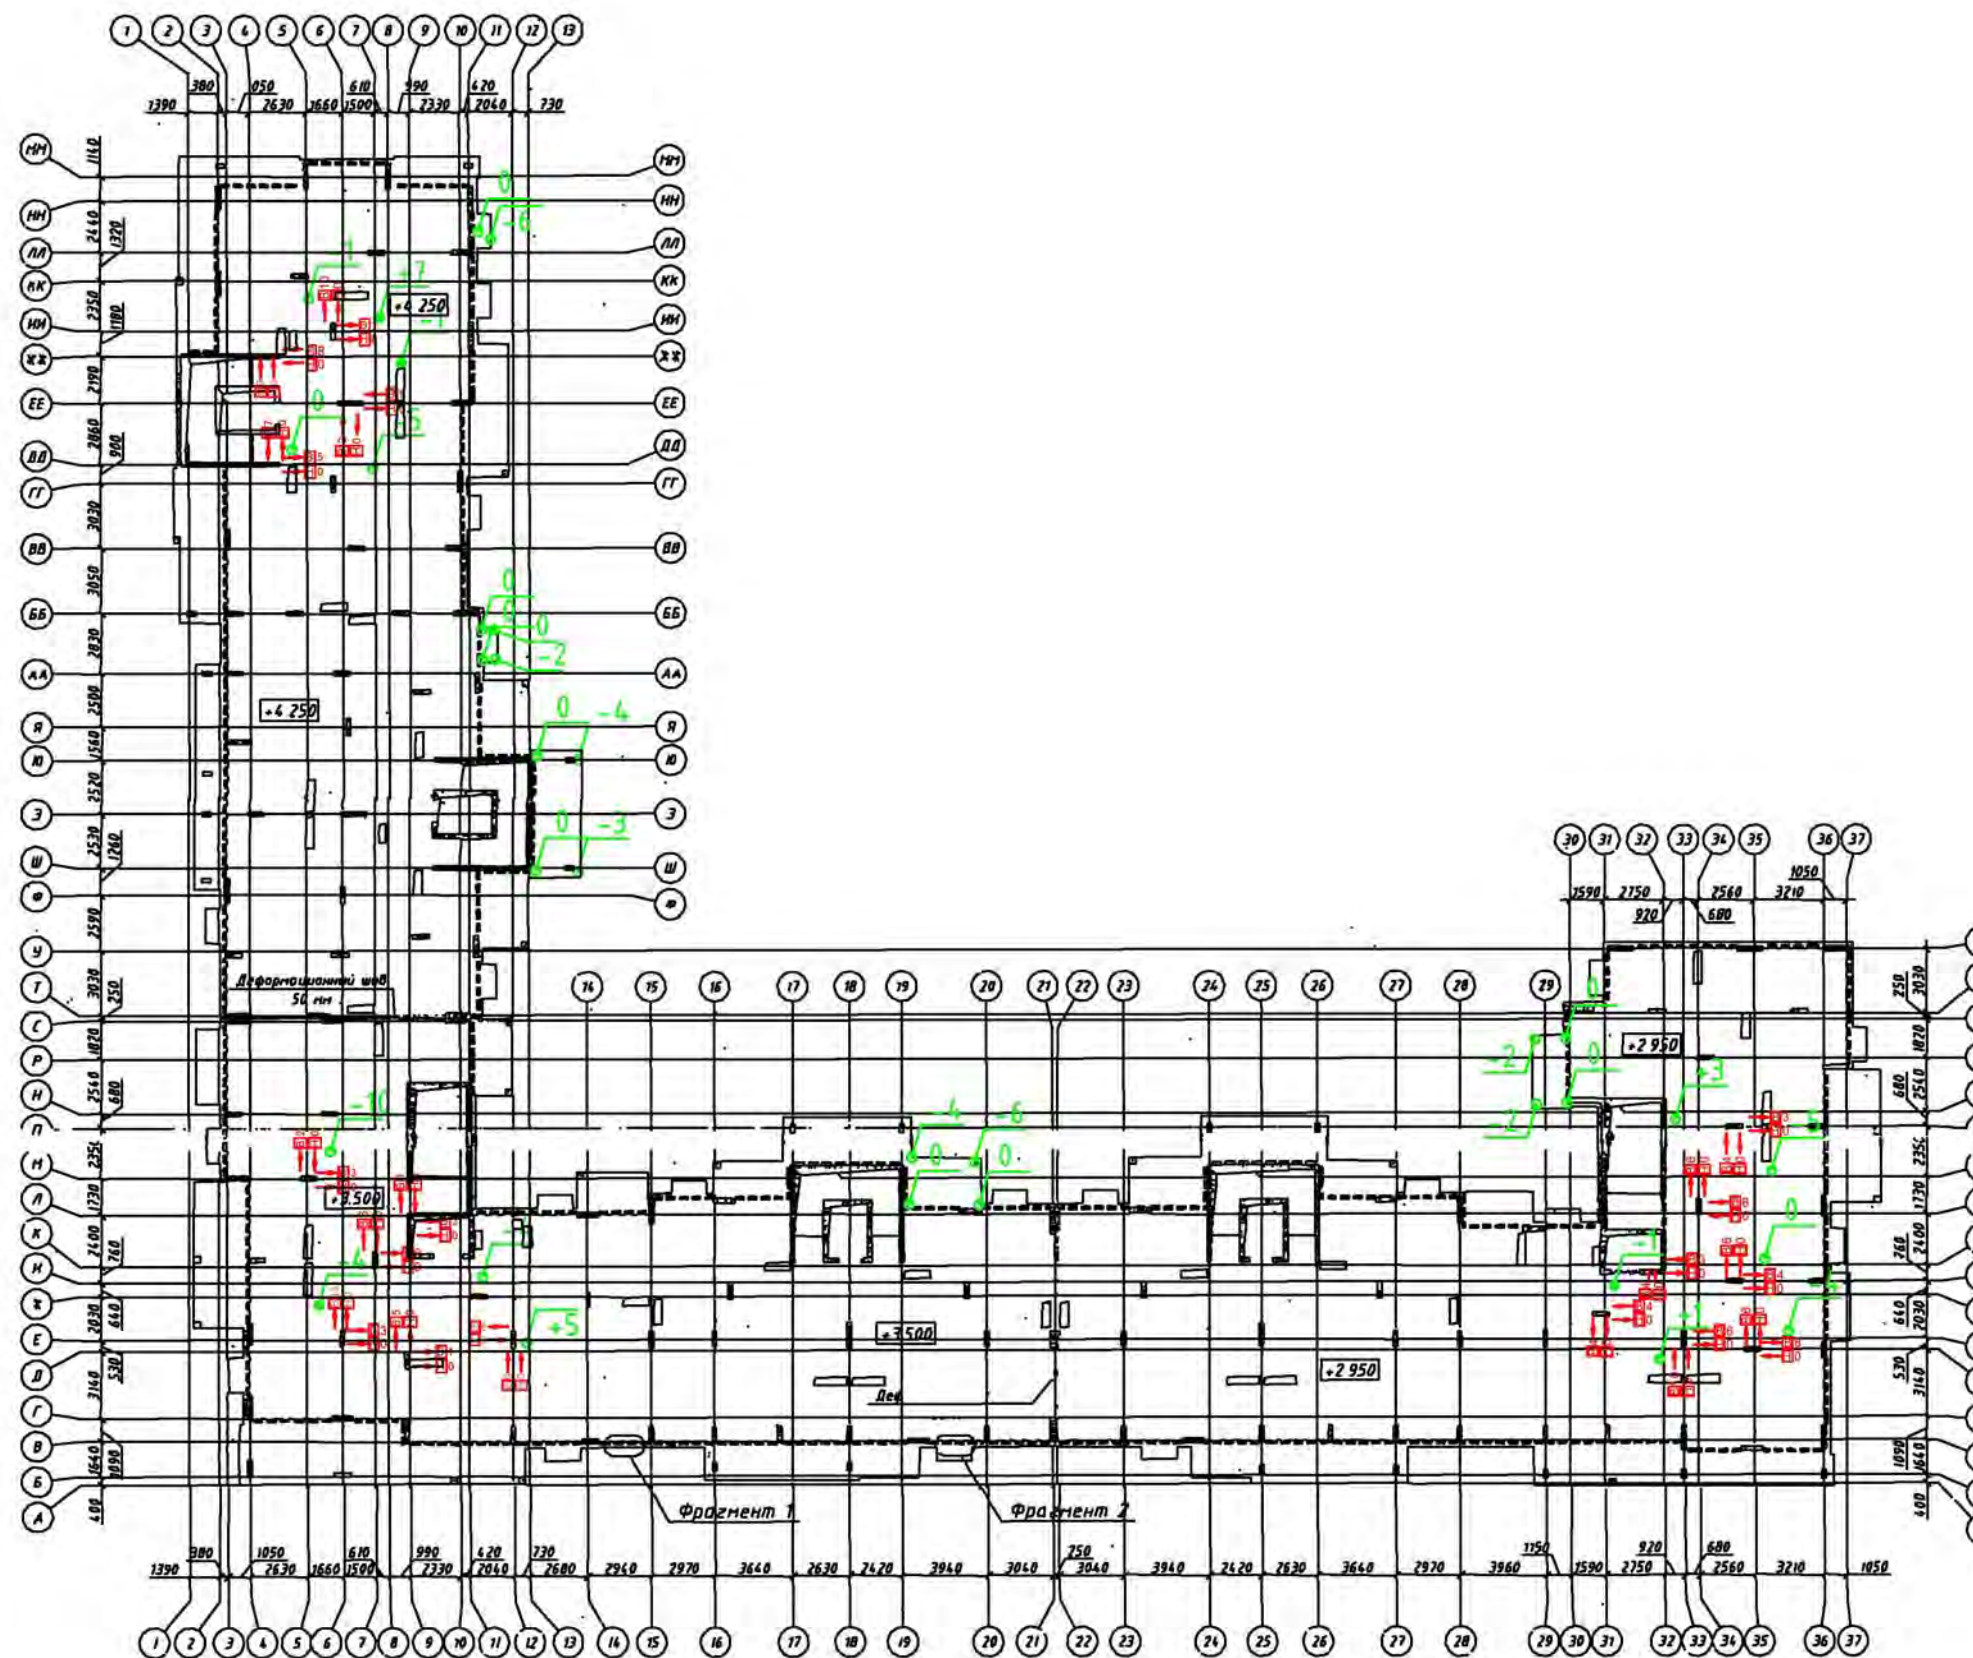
Отклонения от вертикали и горизонтали несущих монолитных железобетонных конструкций 2-го этажа
